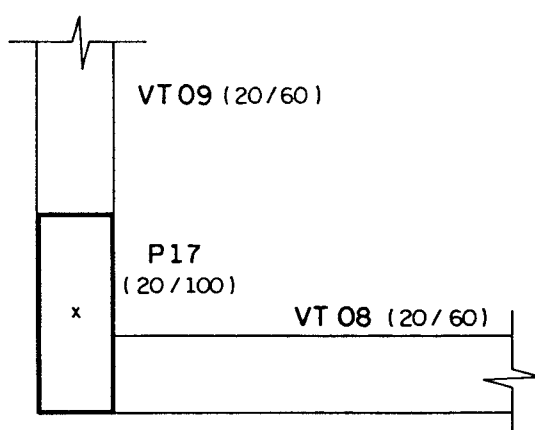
Pilar P17 com as vigas VT08 e VT09 do pavimento-tipo
